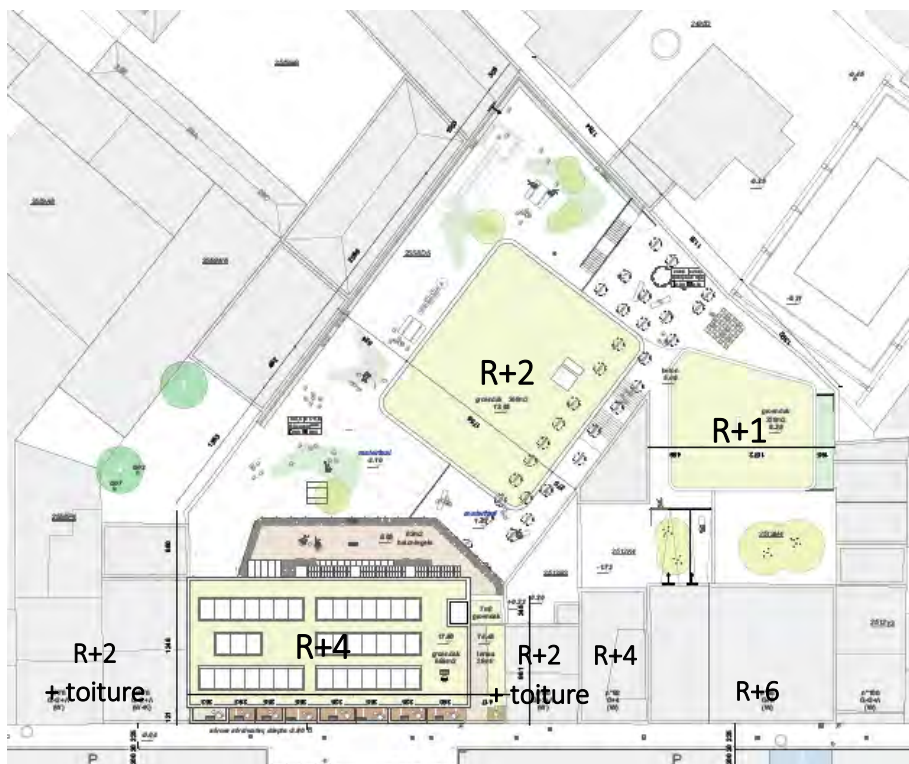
Plan du site avec indication des gabarits des bâtiments (Source : BOB361)
